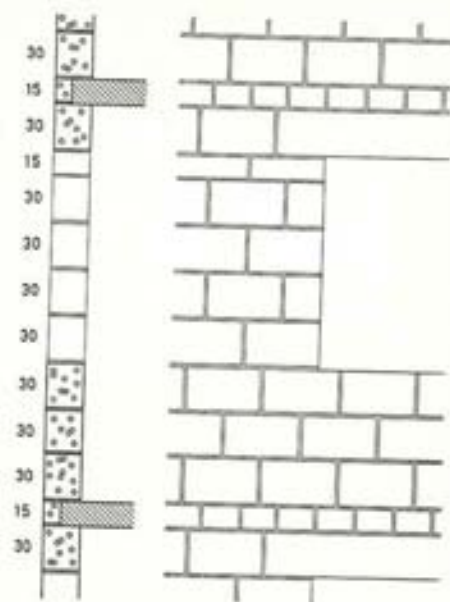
Skiftegangsplan for mur af porebeton.
